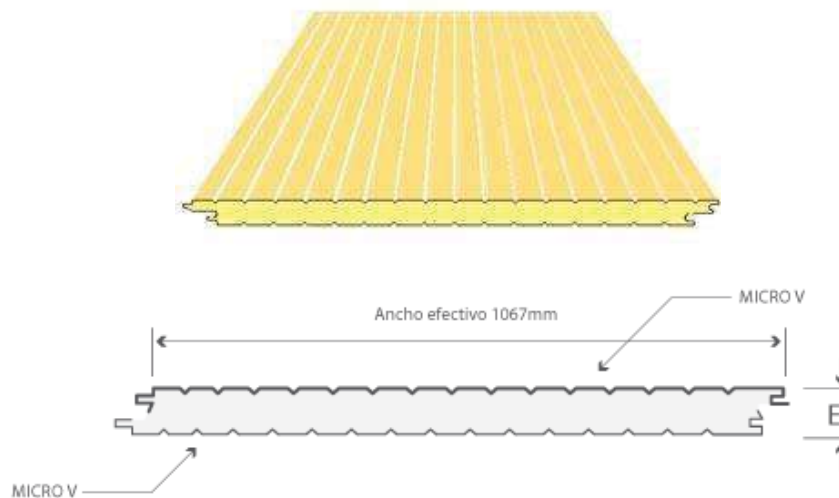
de aislante para muro de perfiles ligeros¹³³
